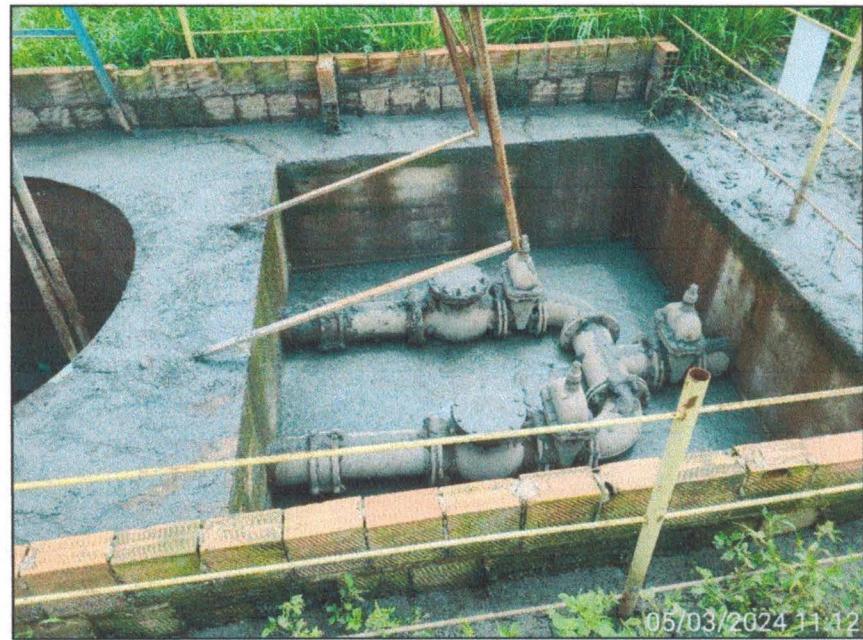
Detalhe do poço das tubulações com esgoto acumulado – EEE Greenville.
